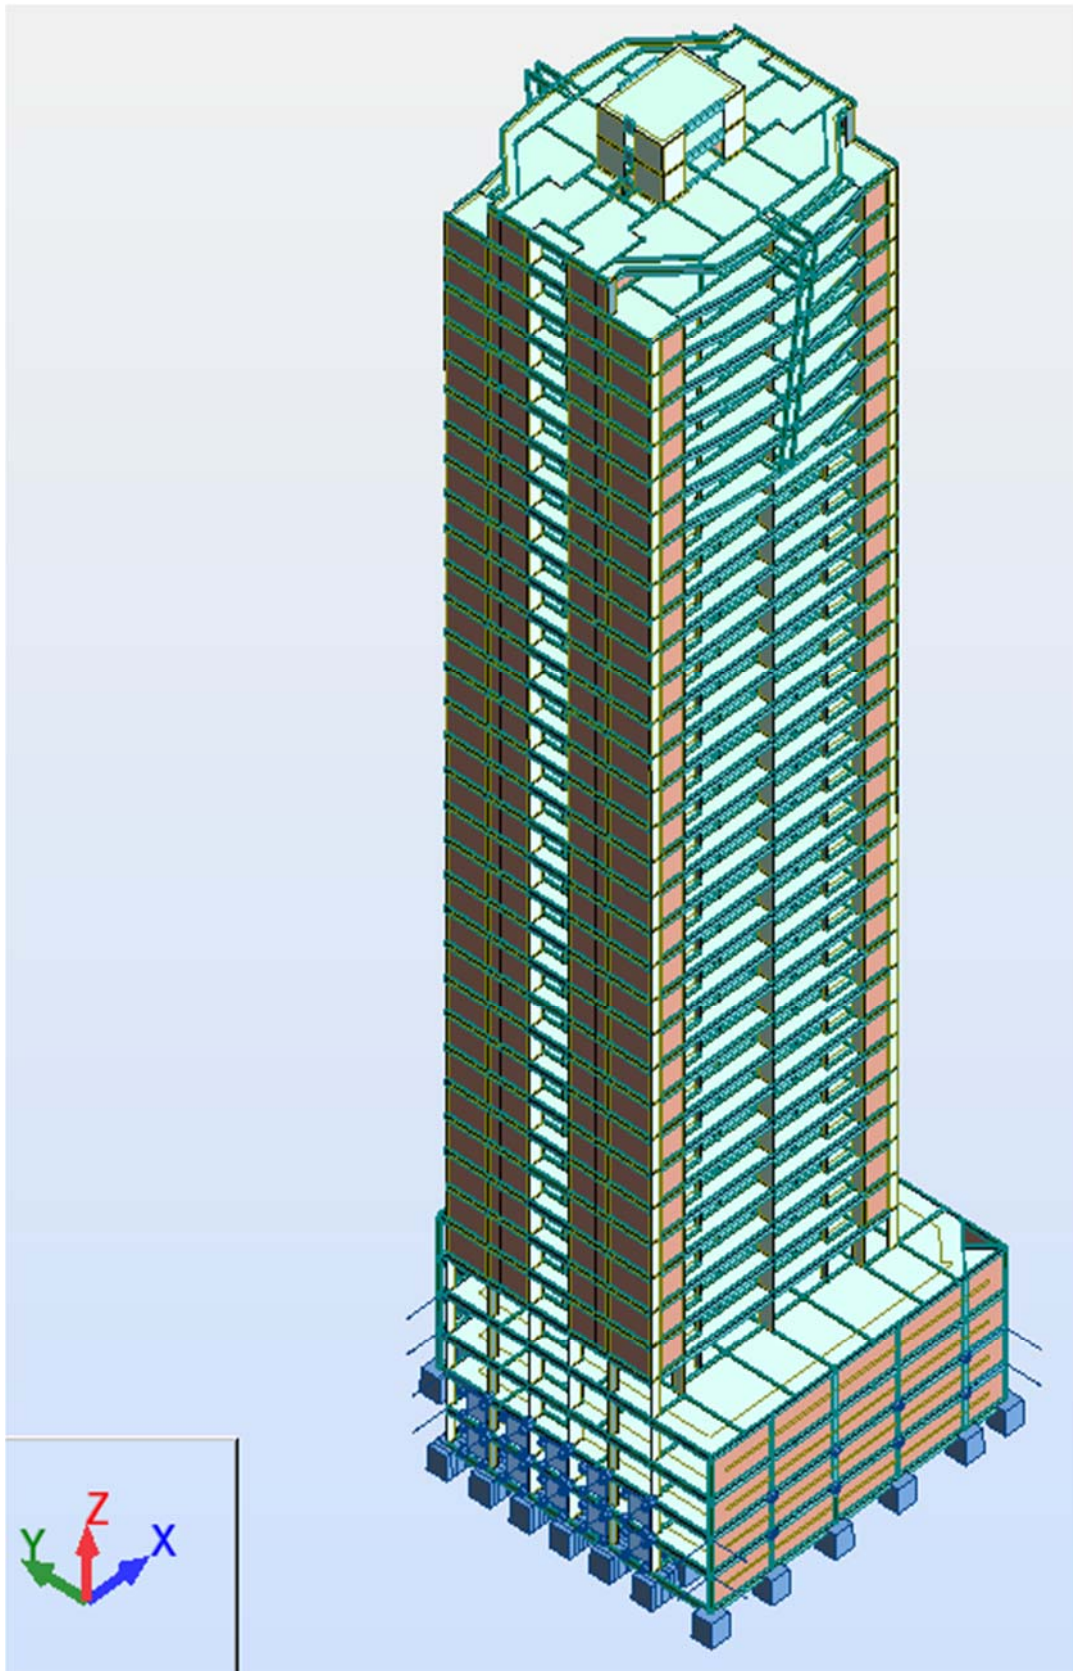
Modelo 2: modelo numérico constituído por elementos estruturais principais (pilares, paredes, vigas e lajes), mais a consideração das paredes de alvenaria por meio de elementos de casca.
